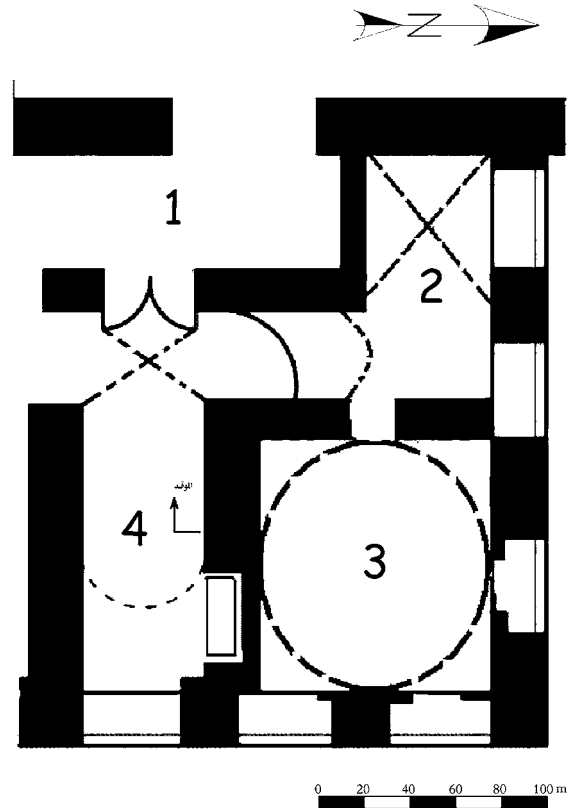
بيت الكعكي: الطابق الأرضي، مسقط أفقي للحمام بالجنح الجنوبي.
